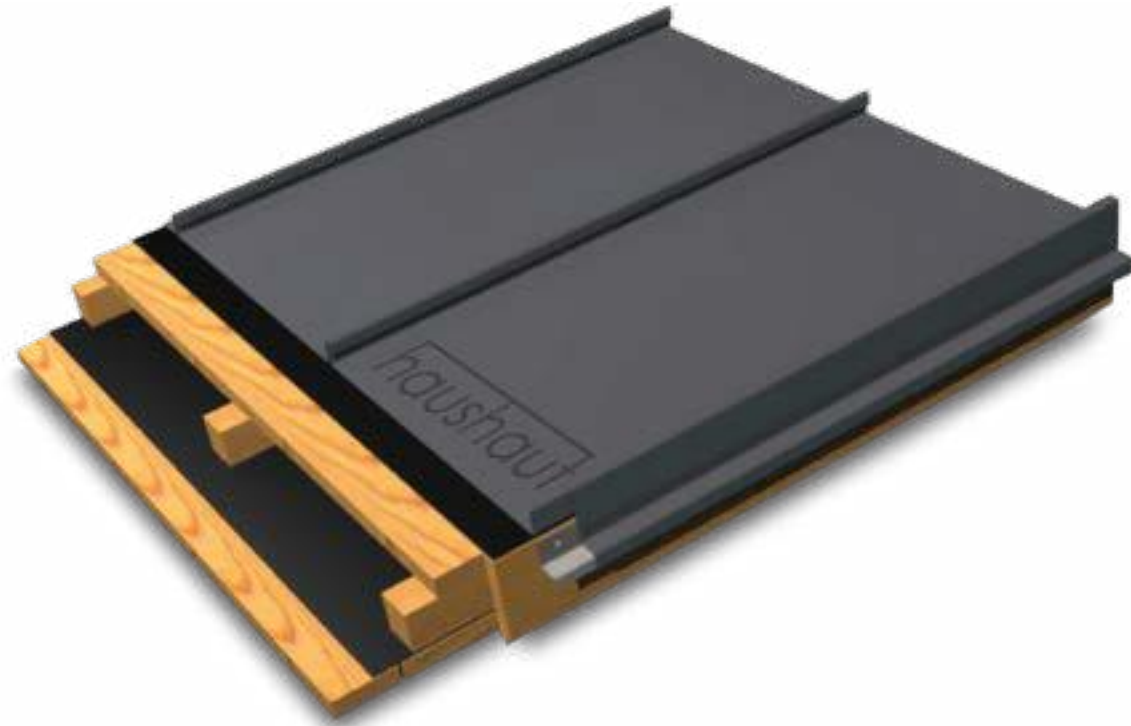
DETAIL ORTGANGAUSBILDUNG VARIANTE 1
